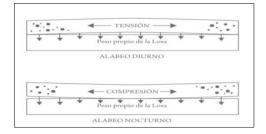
Alabeo de las Losas de los Pavimentos de Concreto
